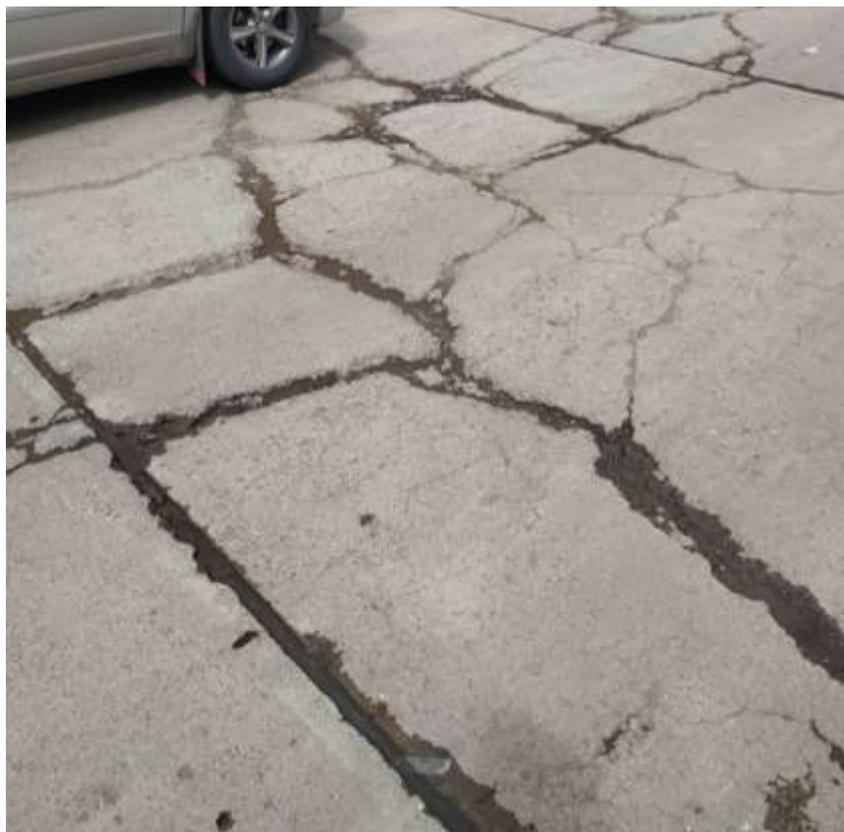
Falla Losa Dividida en Pavimento Rígido.
